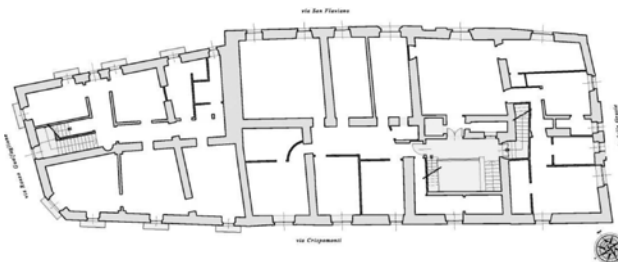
Palazzo Mari a L'Aquila: pianta piano terra
